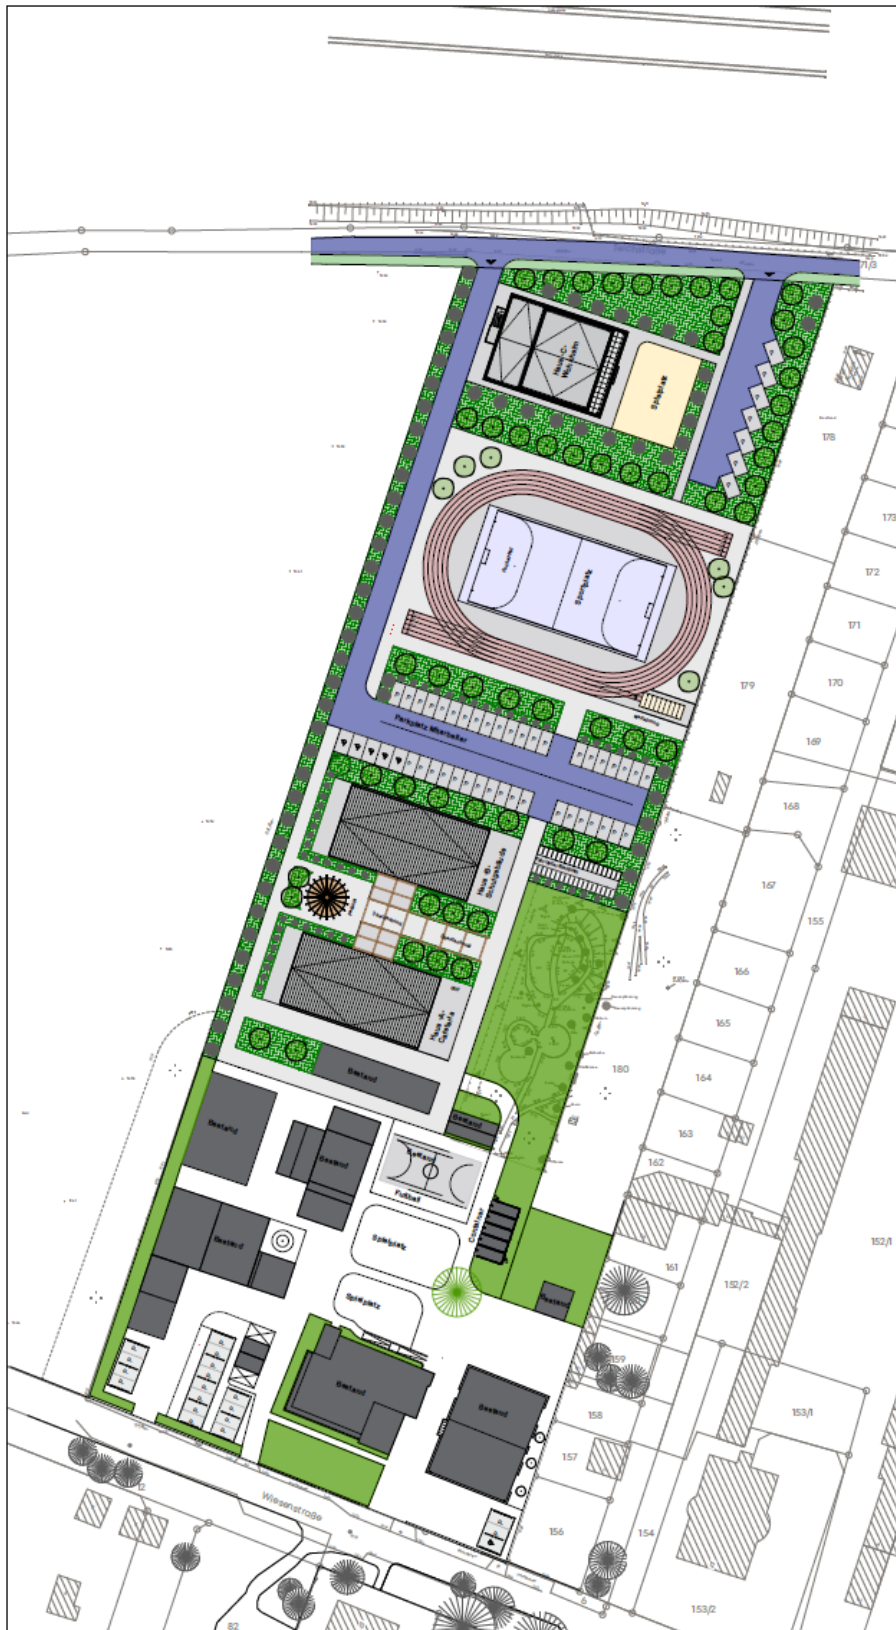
Lageplan und Nachweisorte IOV Verkehrslärm
